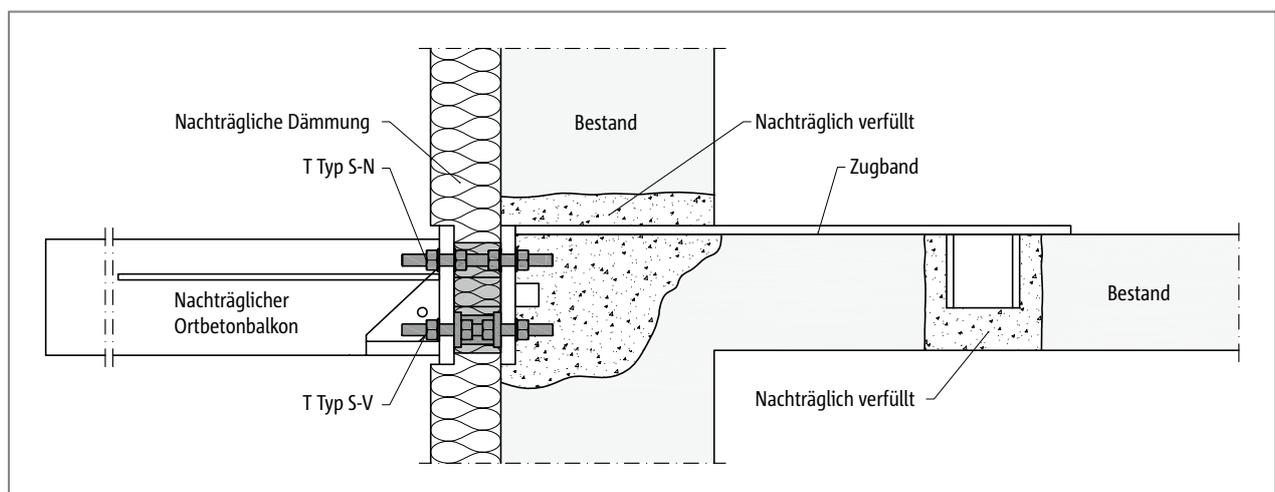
Schöck Isokorb® T Typ S-N und T Typ S-V: Nachträglicher Ortbetonbalkon frei auskragend; mit Zugband angeschlossen an bestehende Stahlbetondecke
